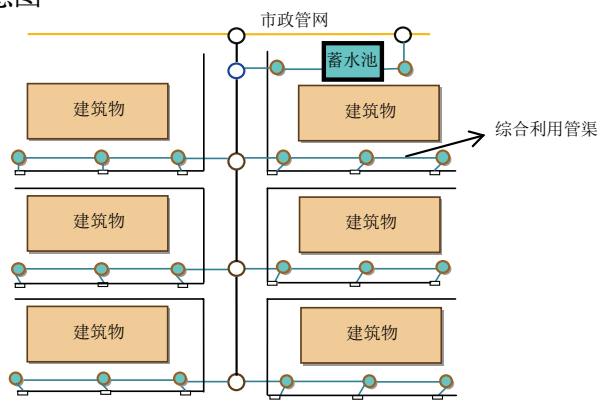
建筑与小区雨水收集与利用系统平面示意图
